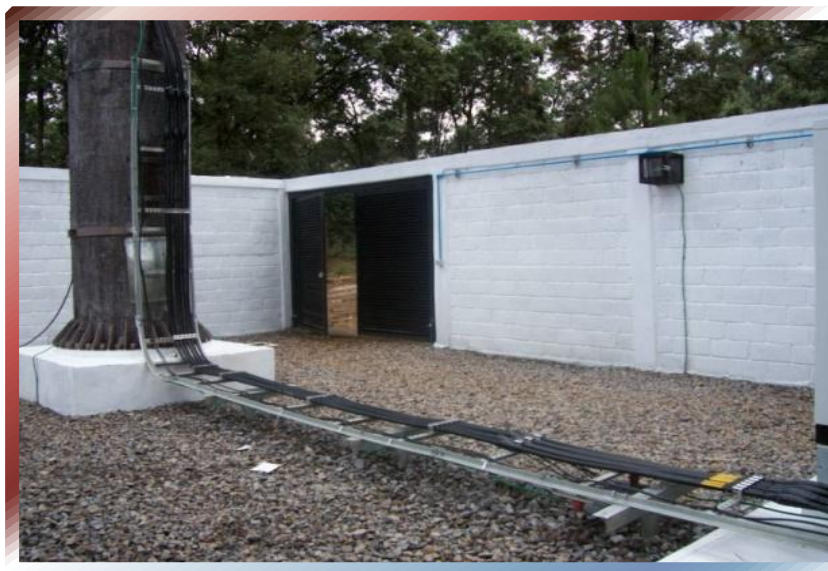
Espacio requerido entre Torre y Barda Perimetral.
